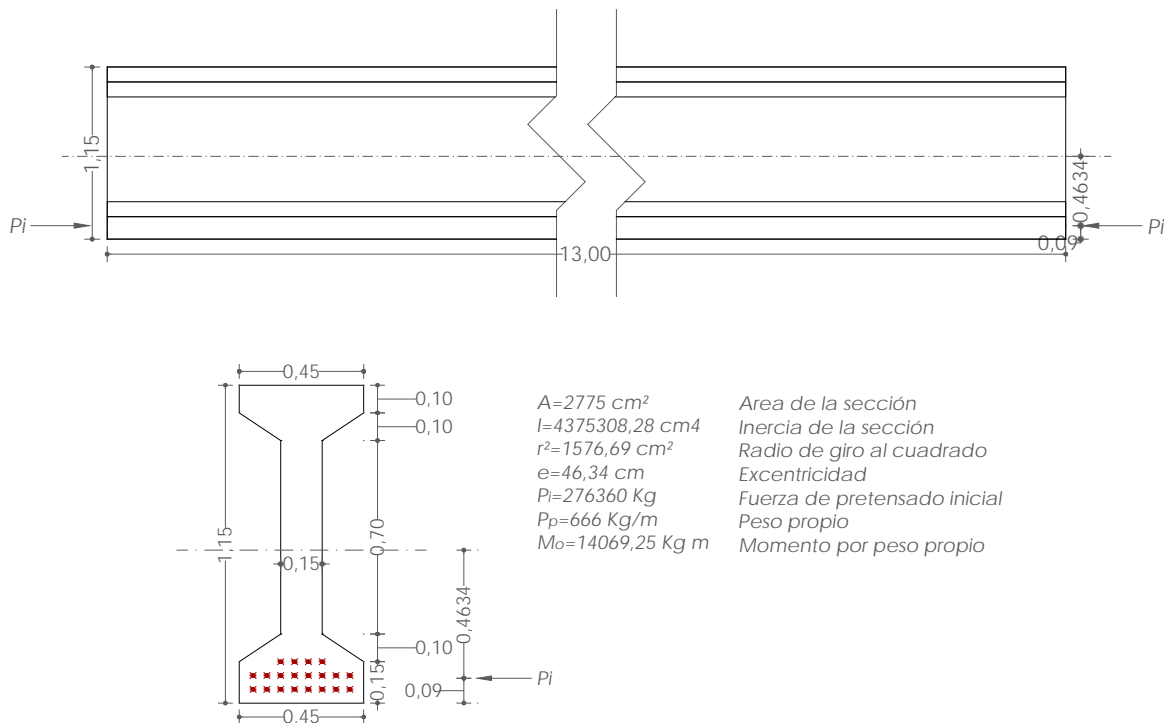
Viga I: vista frontal, sección y propiedades físicas
